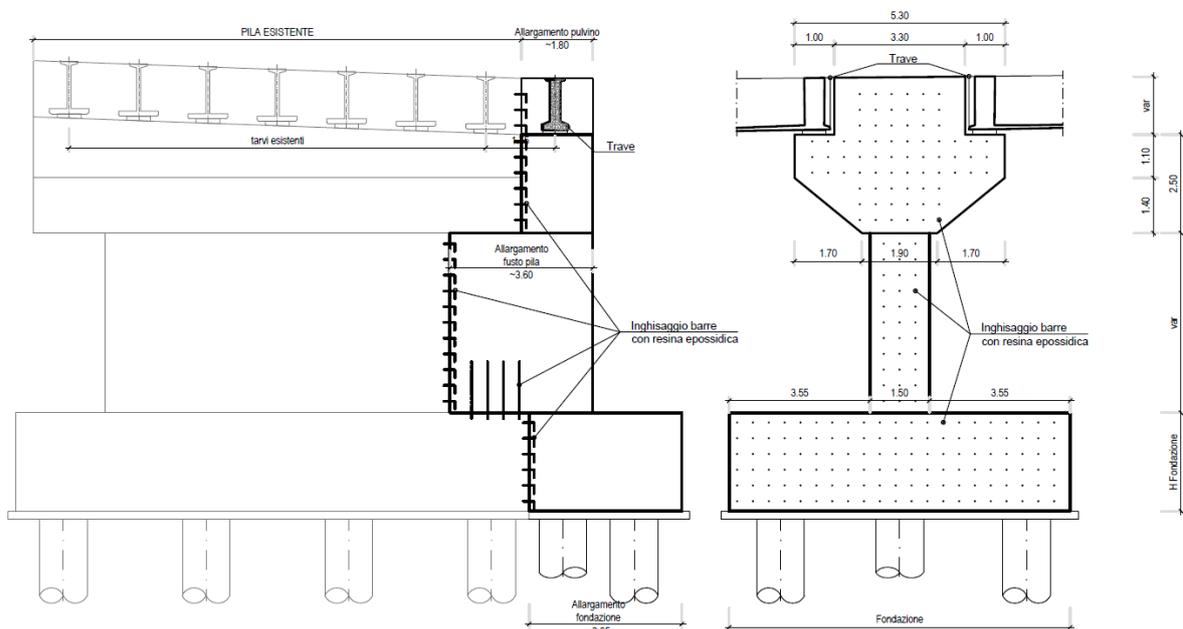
Sezione trasversale pila e pulvino in allargamento
